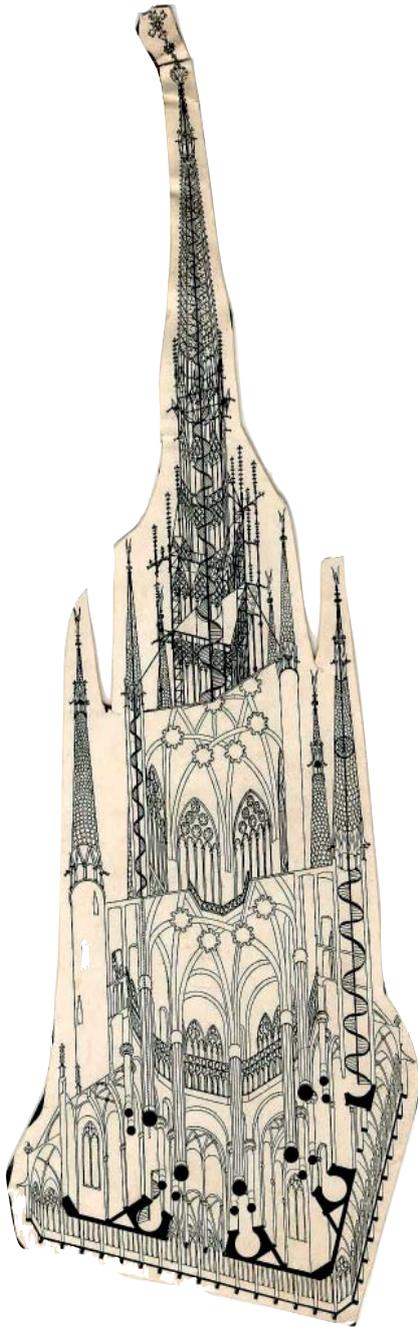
Esquema de planta, alzado y sección. Arxiu Puig i Cadafalch. ANC
